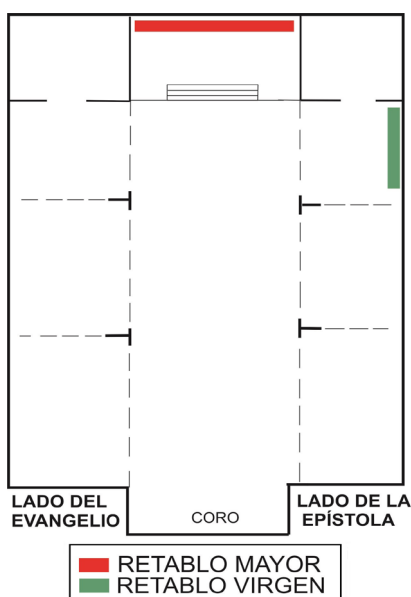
Planta de la Parroquia de San Bernardo Abad.
